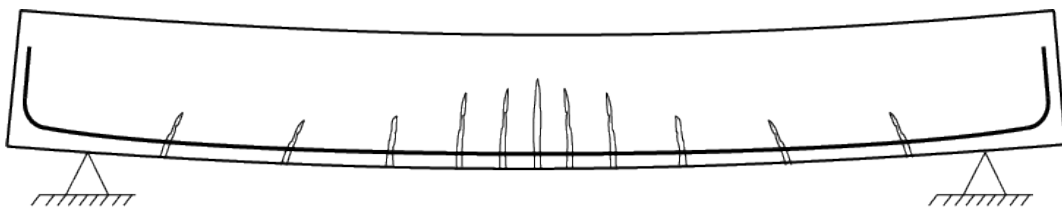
Distribuição de fissuras na viga. Fonte: Adaptado de Guarda (2005).
